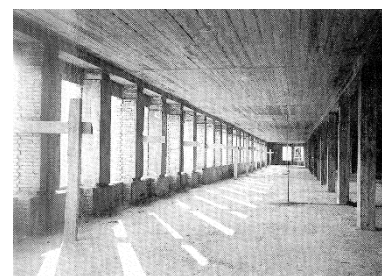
Estructura de hormigón armado, Zaragoza, 1938.
